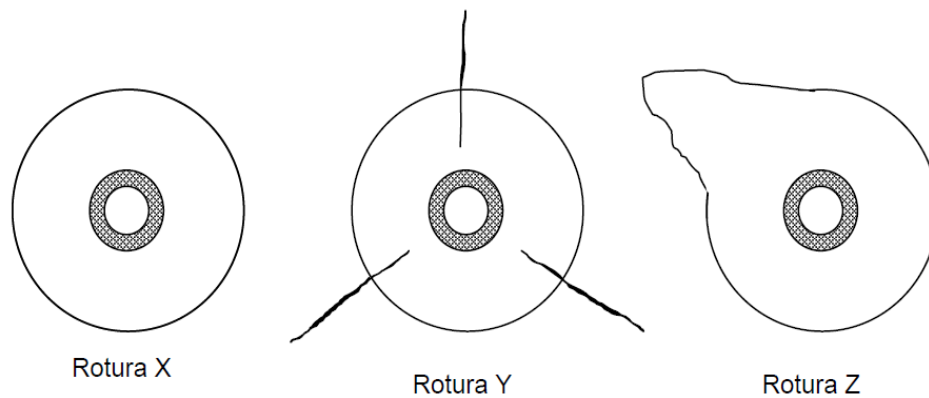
Tipos de roturas num ensaio Lok-test [50]
